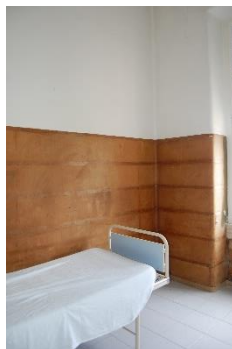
Revestimento da parede interior em cortiça [Fonte: Autora]
